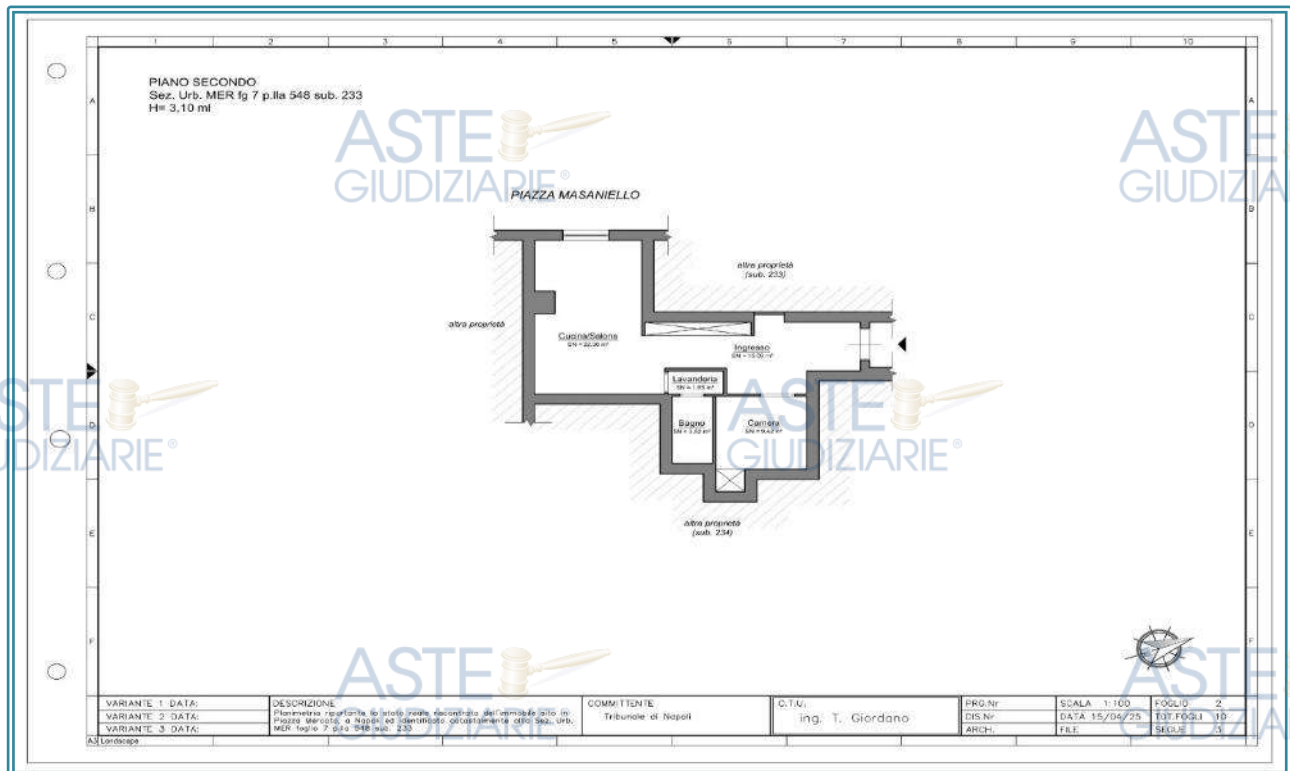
Stato attuale - Piano Secondo (LOTTO 9)
